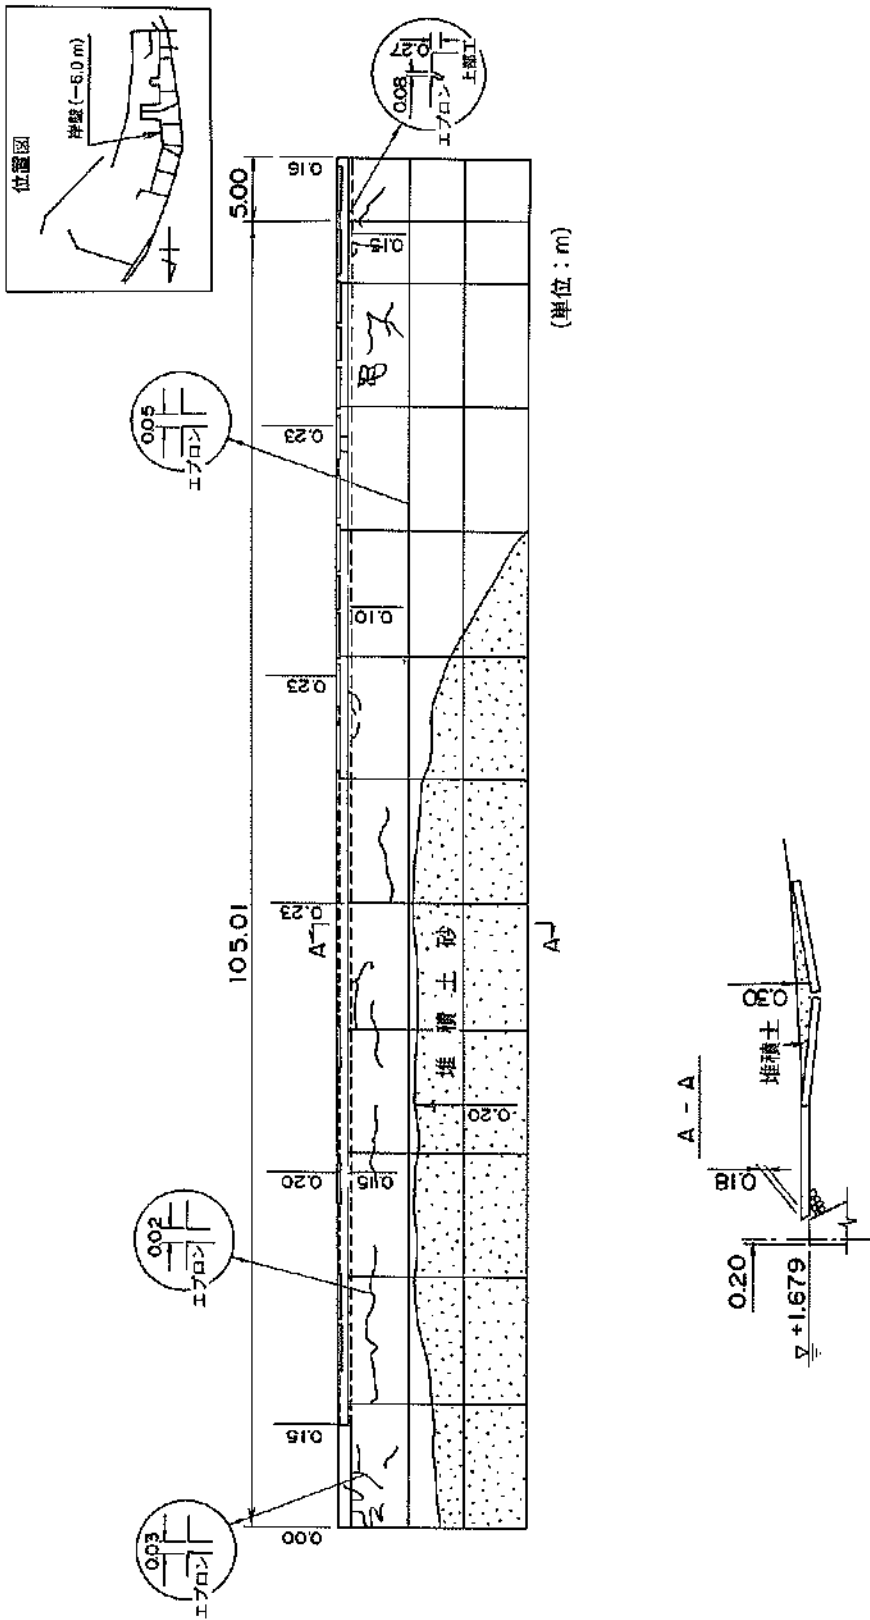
泉尻海岸壁 (-6.0m) の被災状況平面図
